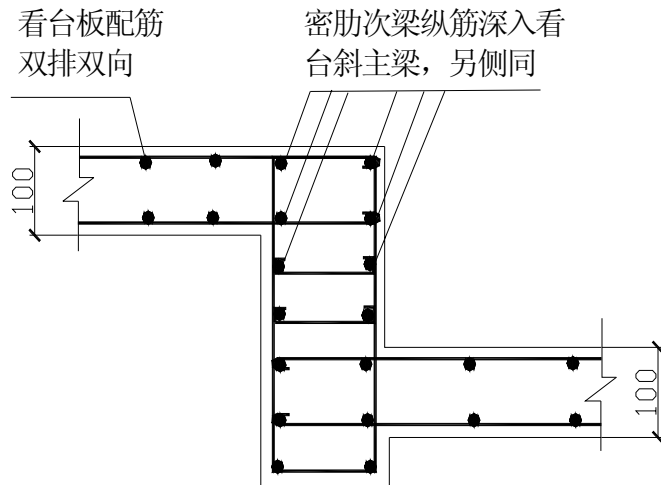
混凝土看台梁板钢筋绑扎示意图
